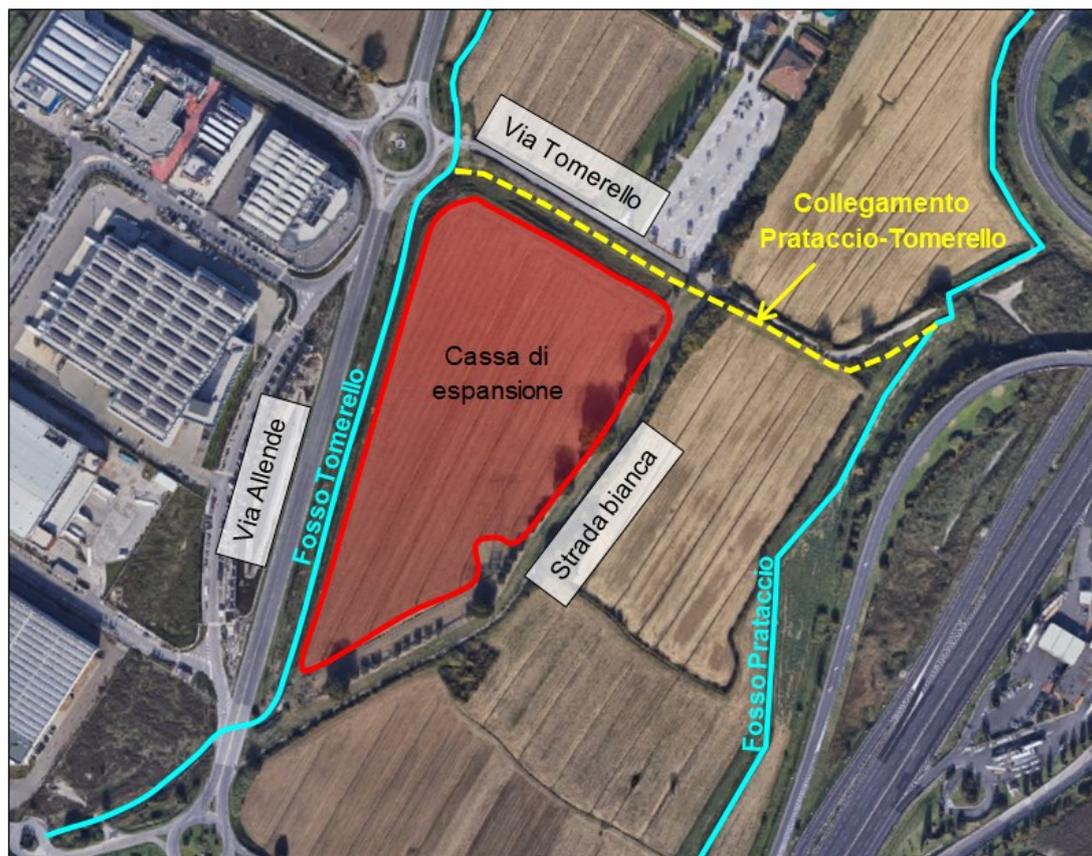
PLANIMETRIA INTERVENTI DI ADEGUAMENTO
